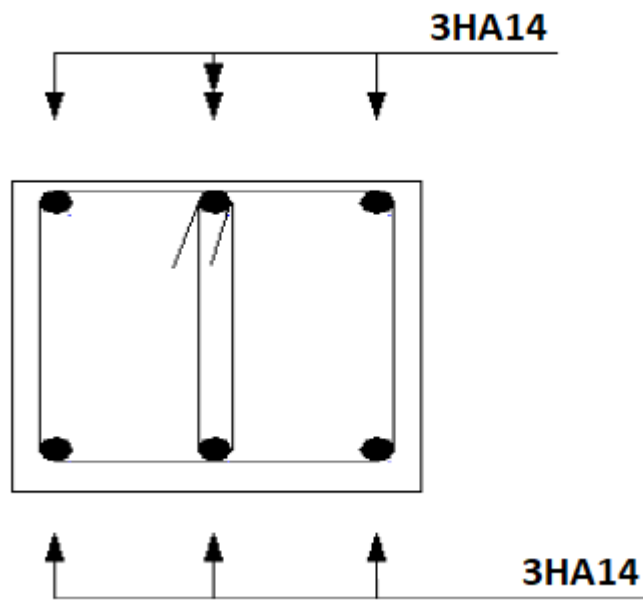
Ferrailage de longrine par Autocad 2012.
